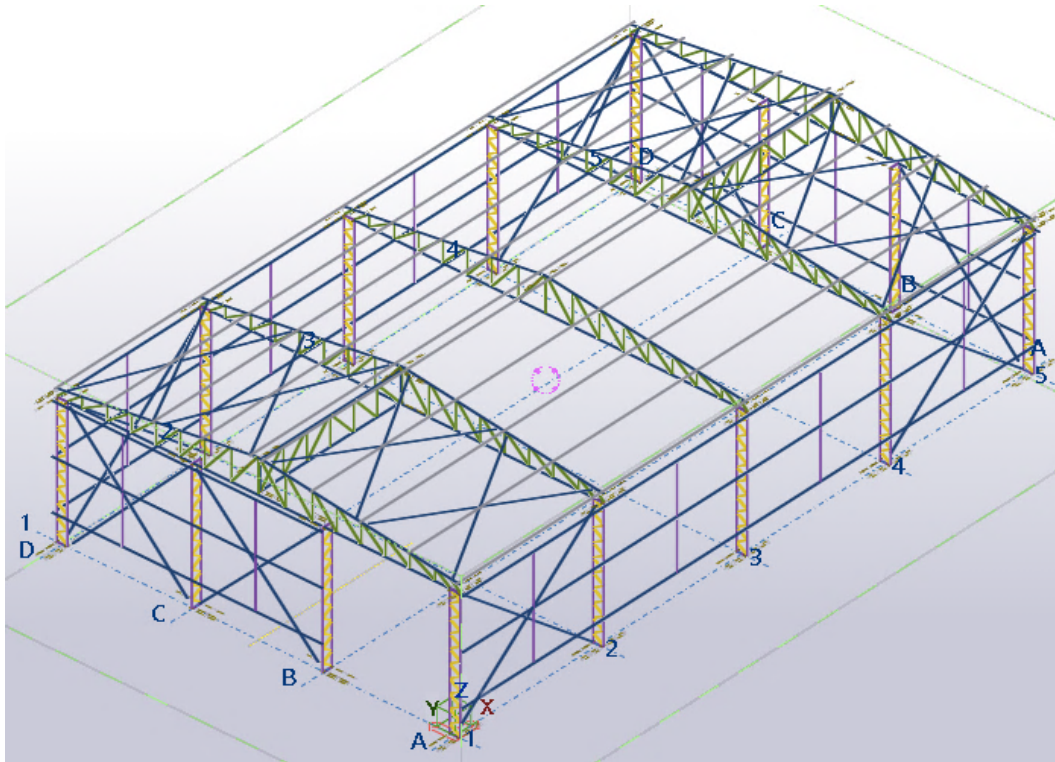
Vista tridimensional da nave industrial no Tekla Structures 2019i
